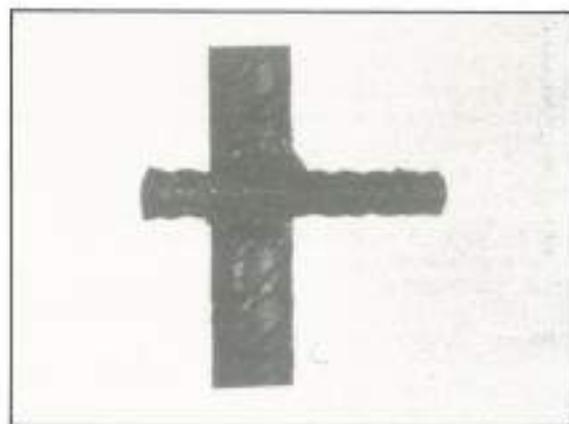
Soldadura en cruz de barras conegadas.
